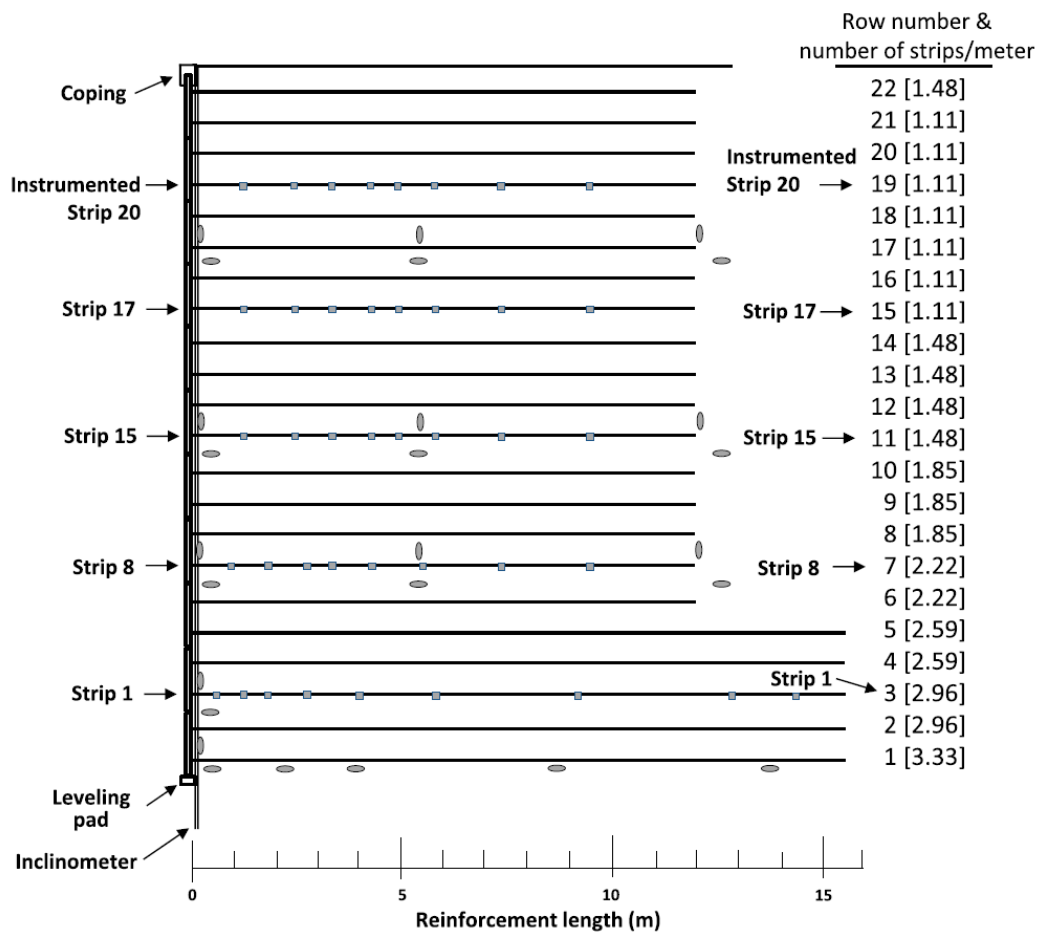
Instrumentación Muro de Minnow Creek. Adaptada Damians et al. (2014).
